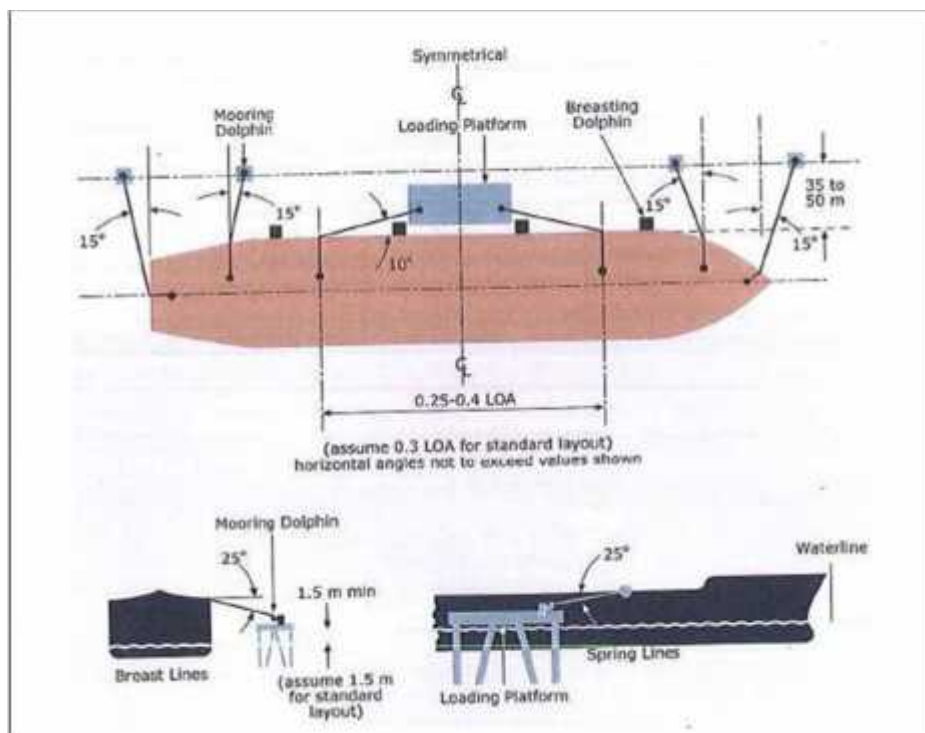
Layout ottimale sistema di ormeggio – Soluzione n°1
